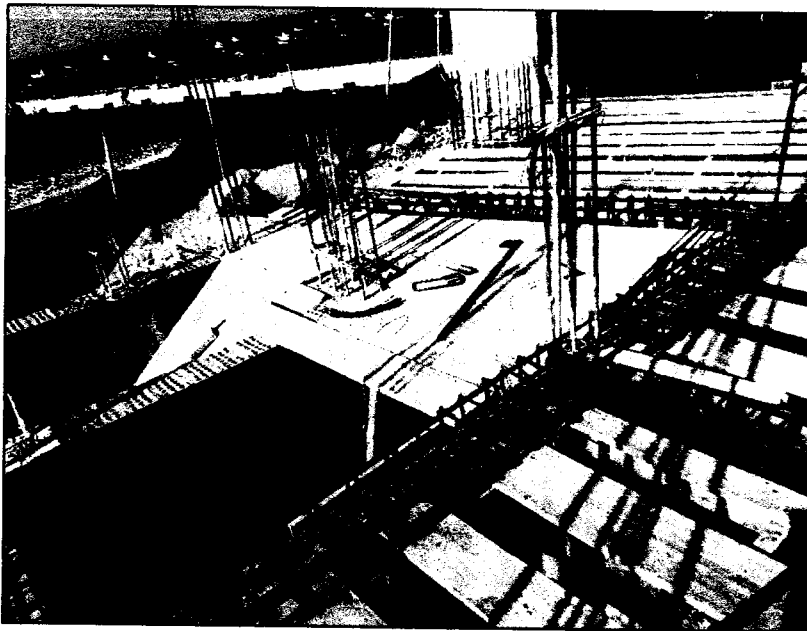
Encofrado para la losa aligerada del Edificio de Desinfección
